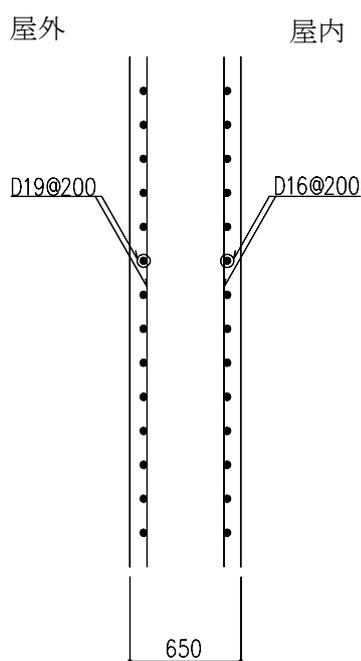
耐震壁の配筋図 (地下1階, YH通り X17~X18 通り間) (単位: mm)
